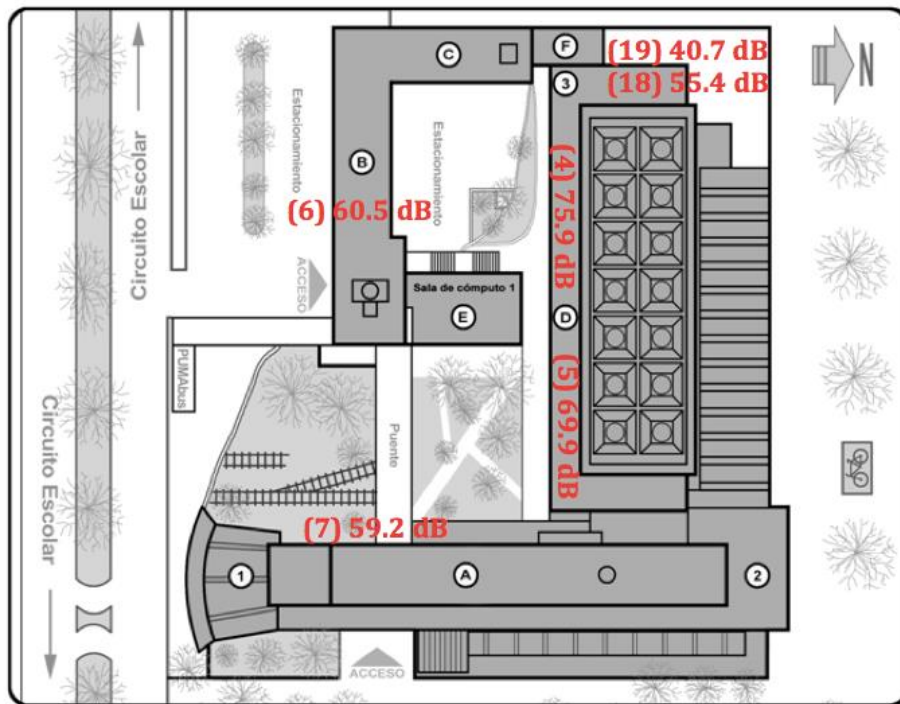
Conjunto Norte de la Facultad de Ingeniería
